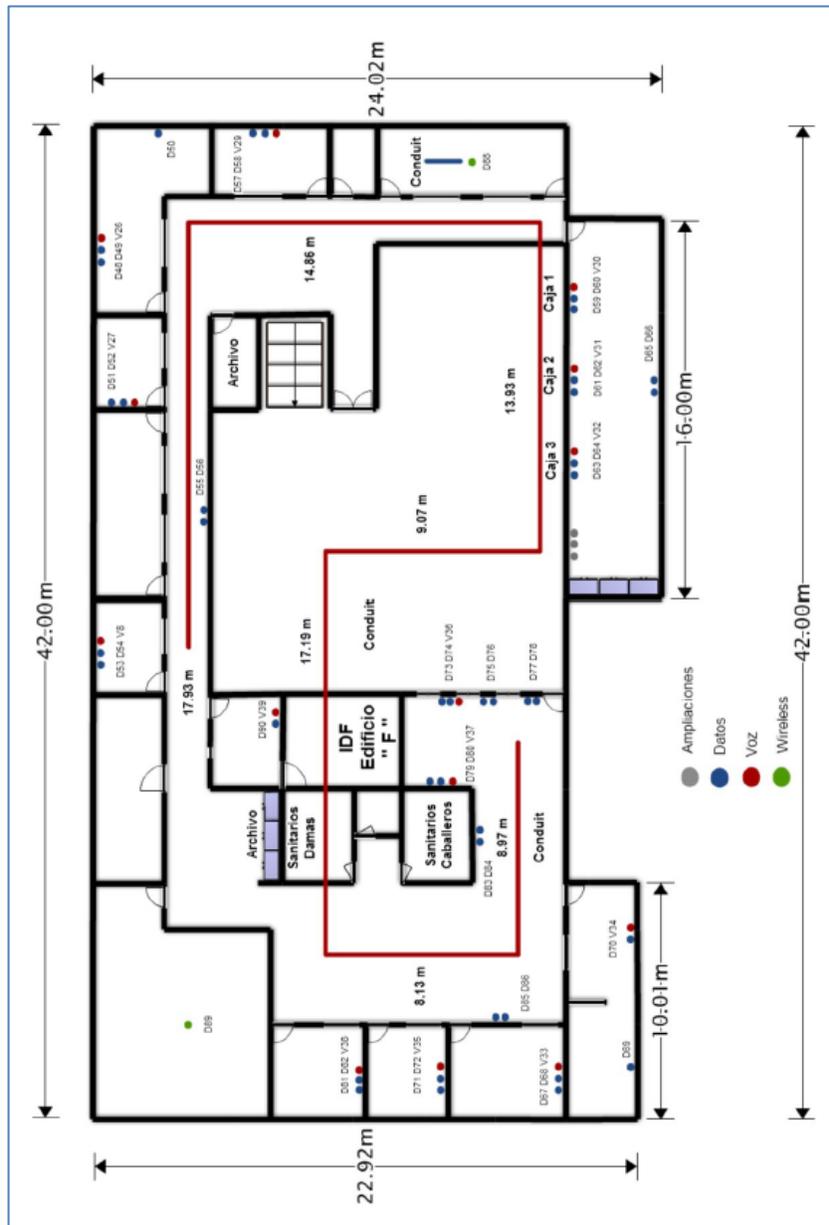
Ruta Cableado por escalerilla Primer Piso
